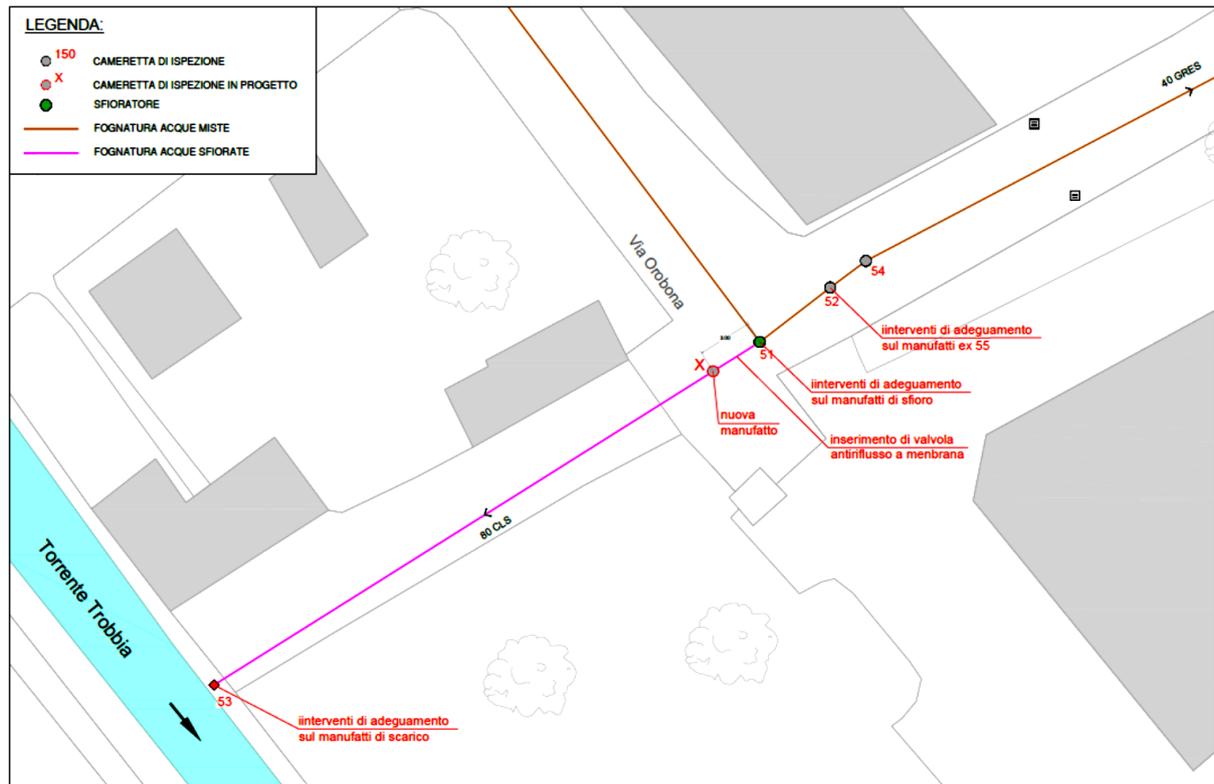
Planimetria stato di progetto intervento 1 – scarico n.1 (ID 53) e manufatto di sfioro (ID 51)
